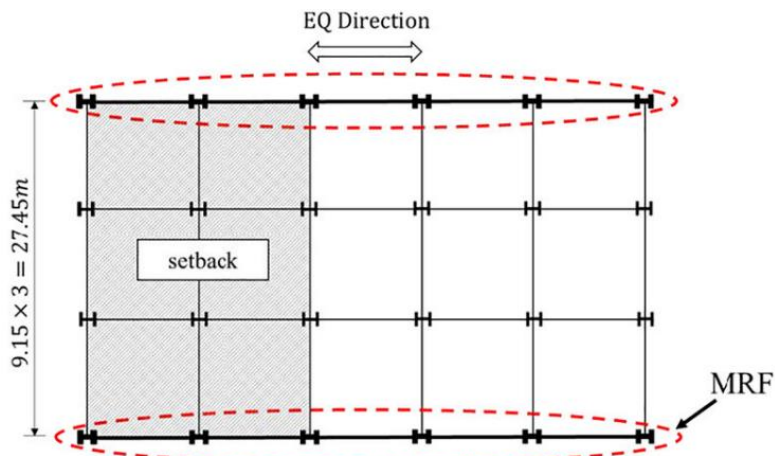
Vista en planta edificio de 9 pisos con retroceso en altura.
